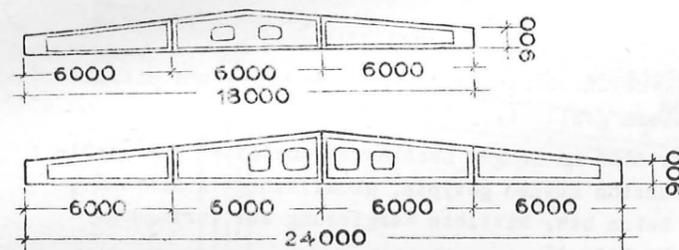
Spannbeton-Satteldach-Vollwandbinder, zusammengespannt
